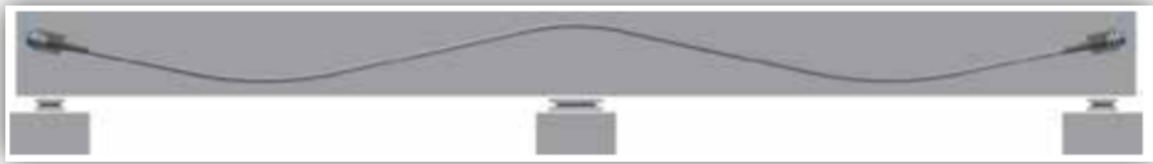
Esquema de pieza de hormigón con armaduras postensadas(Argila, 2018).
